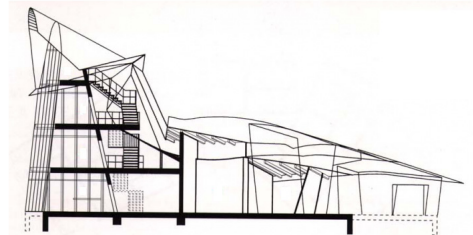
Sezione trasversale; Fonte: D. Hay, 2011;
